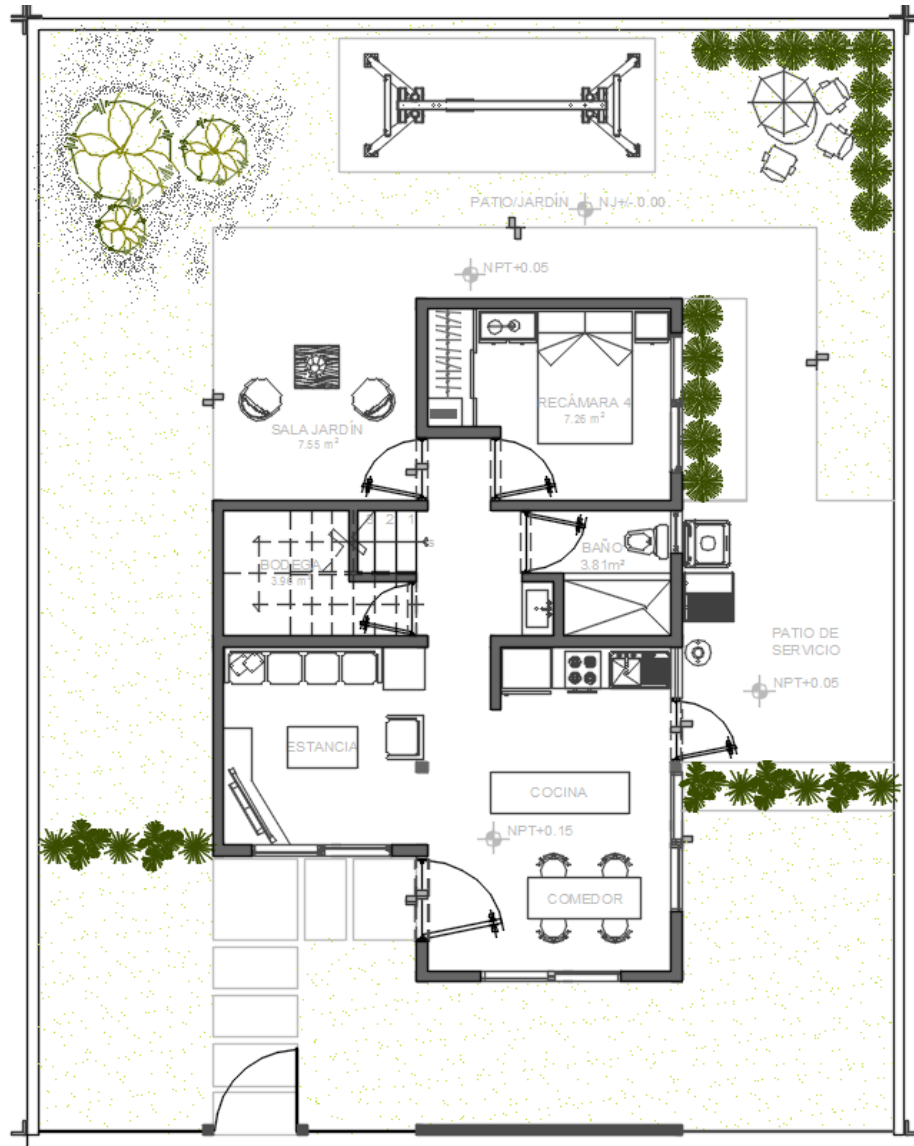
Plano arquitectónico de vivienda prototipo A. Plano de elaboración propia, 2017. Véase pág. 106.
